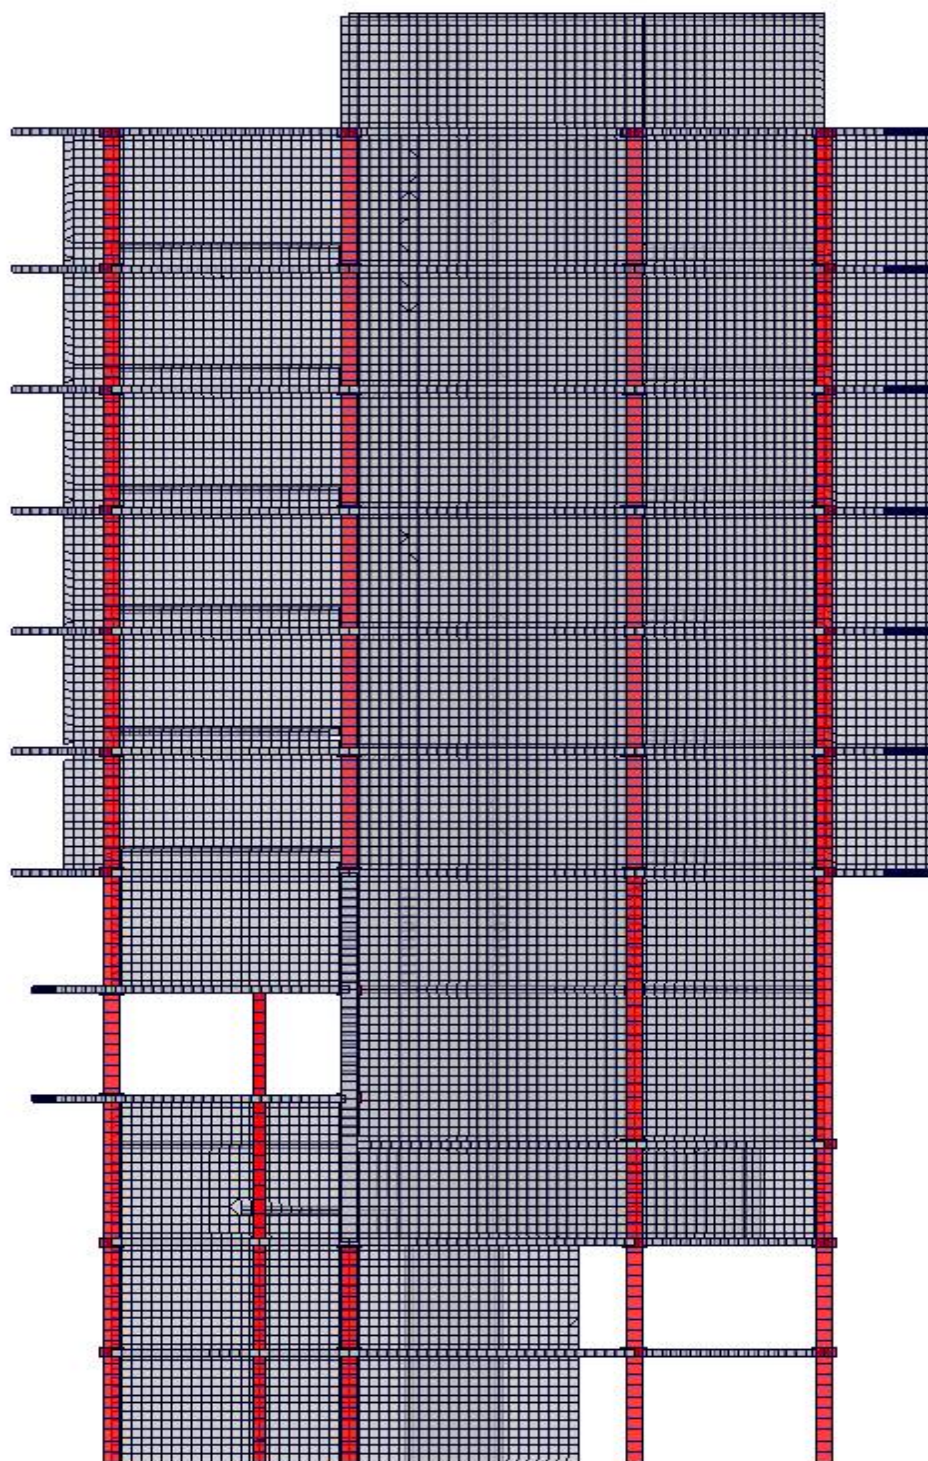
Вид расчетной схемы жилой части здания со стороны фасада
